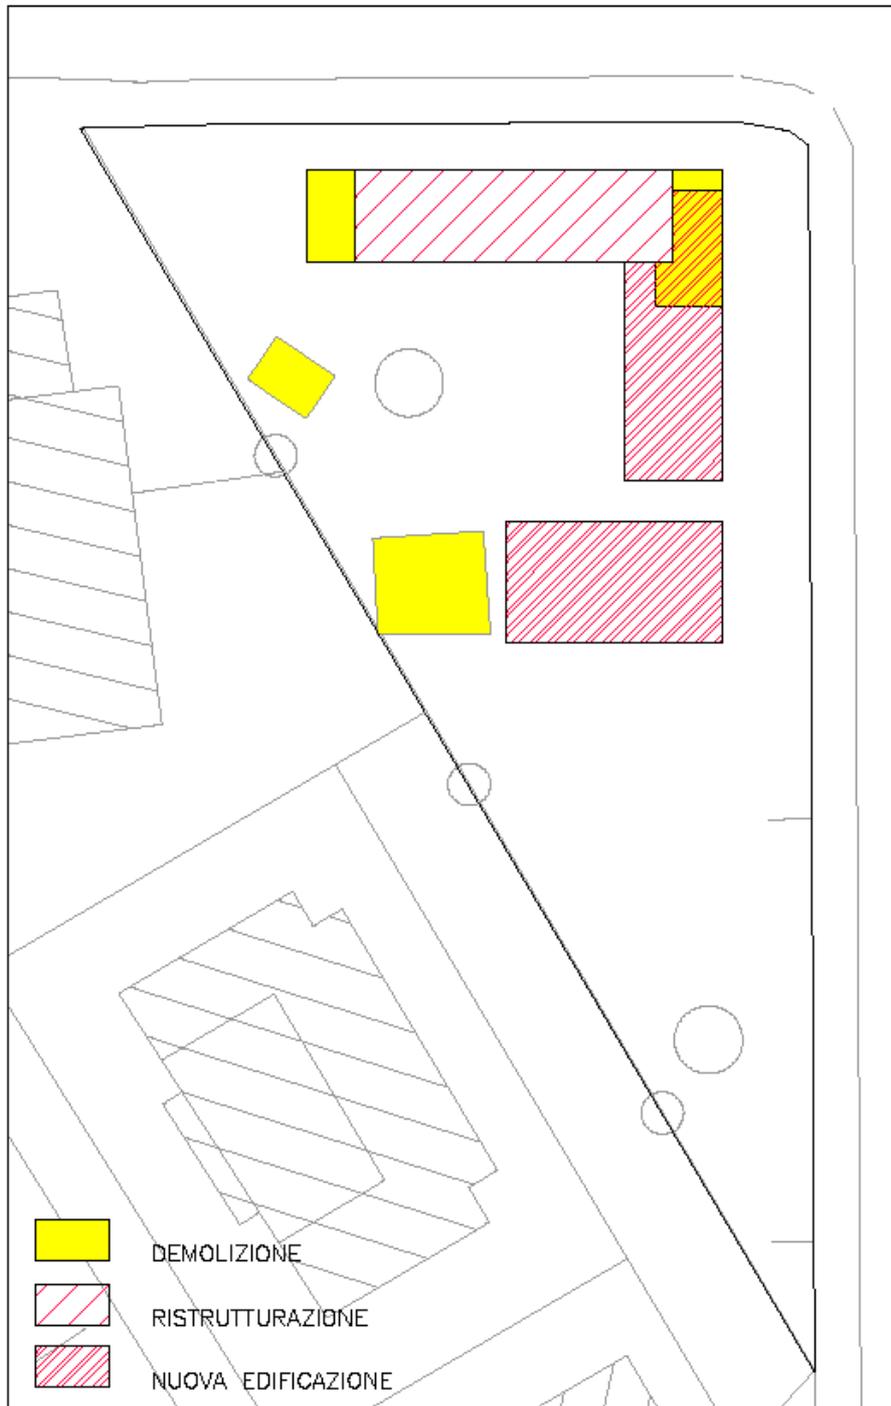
schema planimetrico con evidenziati gli interventi edilizi
